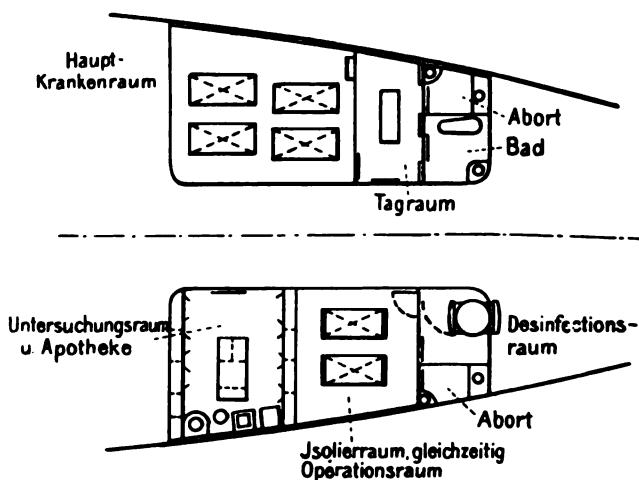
Schiffslazarett mit 12 Betten nach BELLI.
